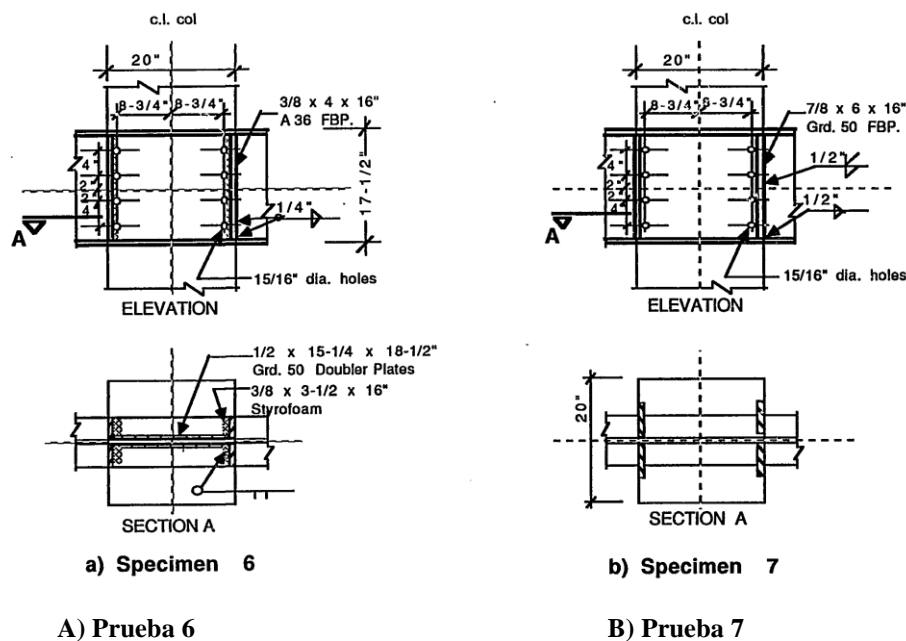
Detalles De Las Vigas En El Área De La Junta: A) Para La Muestras 6, B) Detalle Para La Muestra 7. Nota. Shikh muhammad t. moment connections between steel beams and concrete columns (1987) (pág.45)
